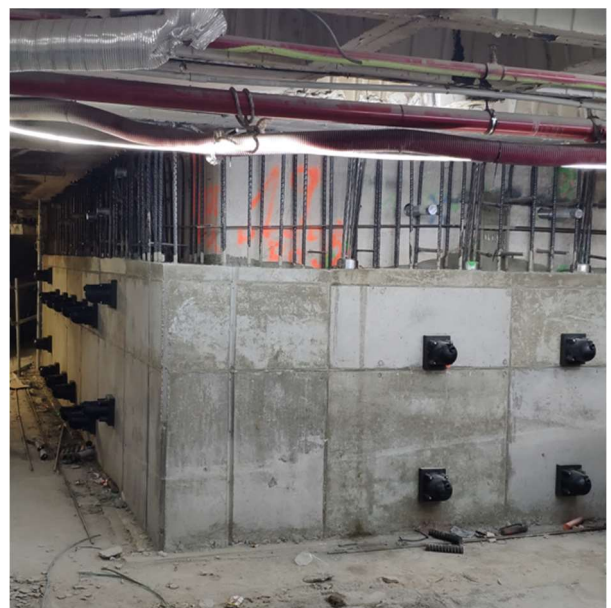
Fase de tesado de barras horizontales y de tendones verticales.
